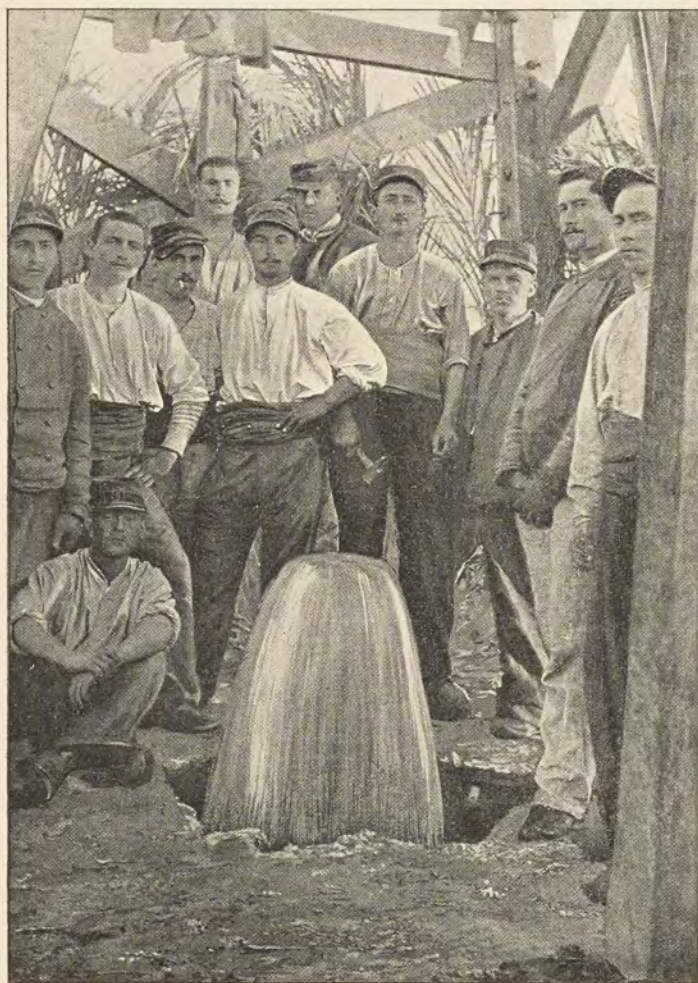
Un groupe de « joyeux » autour d'un puits jaillissant.
